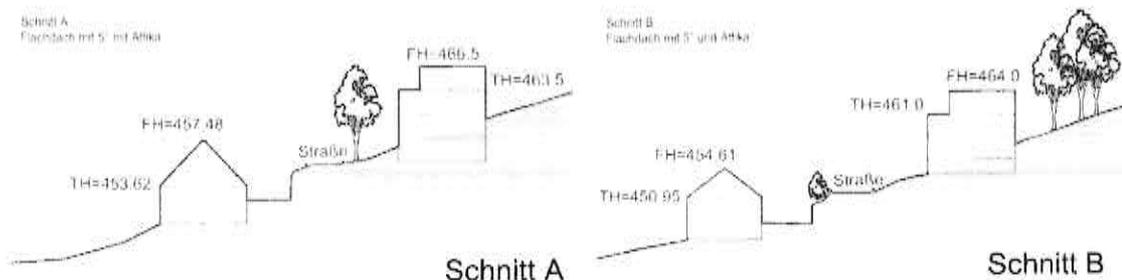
Schematische Darstellung einer möglichen Bebauung mit einem Attika-Geschoss und einem Flachdach (eigene Darstellung)
